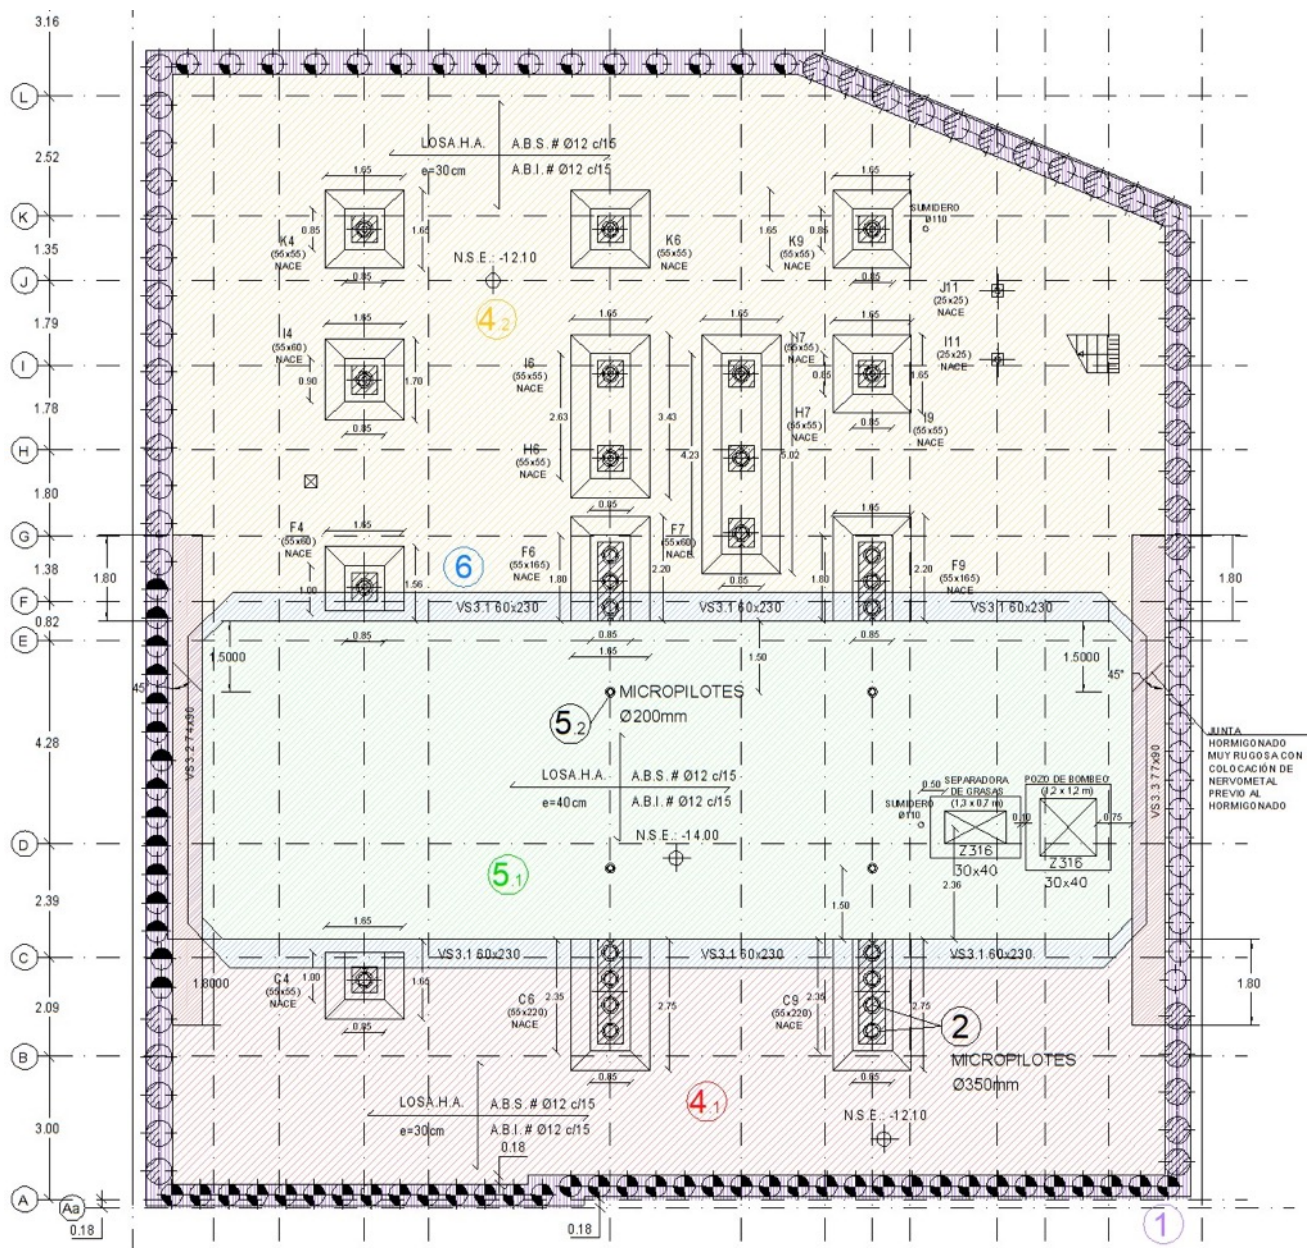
Planta de cimentación, nivel 5, cota -12.10 m. Geometría encepados micropilotes en losa de cimentación e indicación de fases constructivas.
